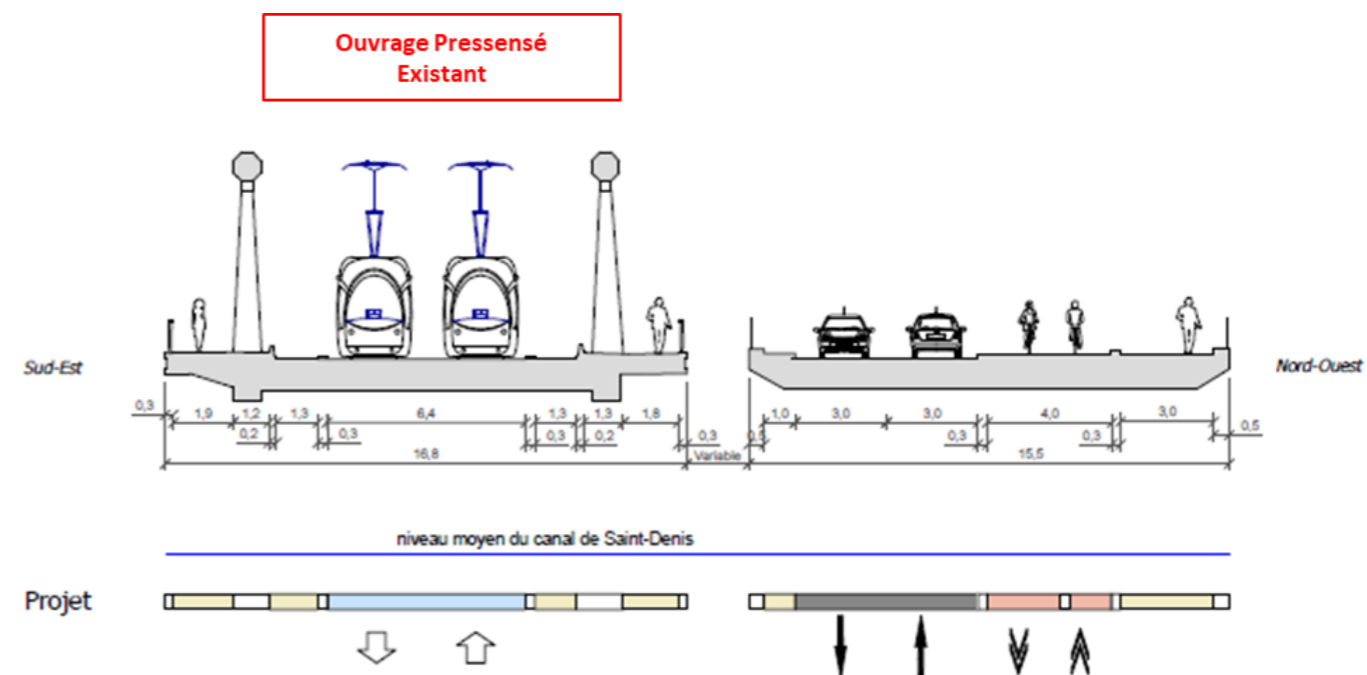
Projet T8 Sud sur ouvrage existant et nouvel ouvrage (coupe n°10)
